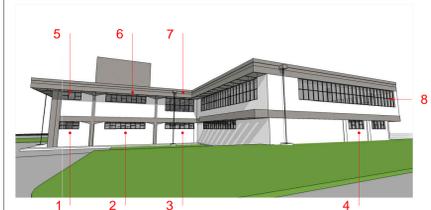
fachada Sudoeste existente - DIA 22 dezembro às 16h
